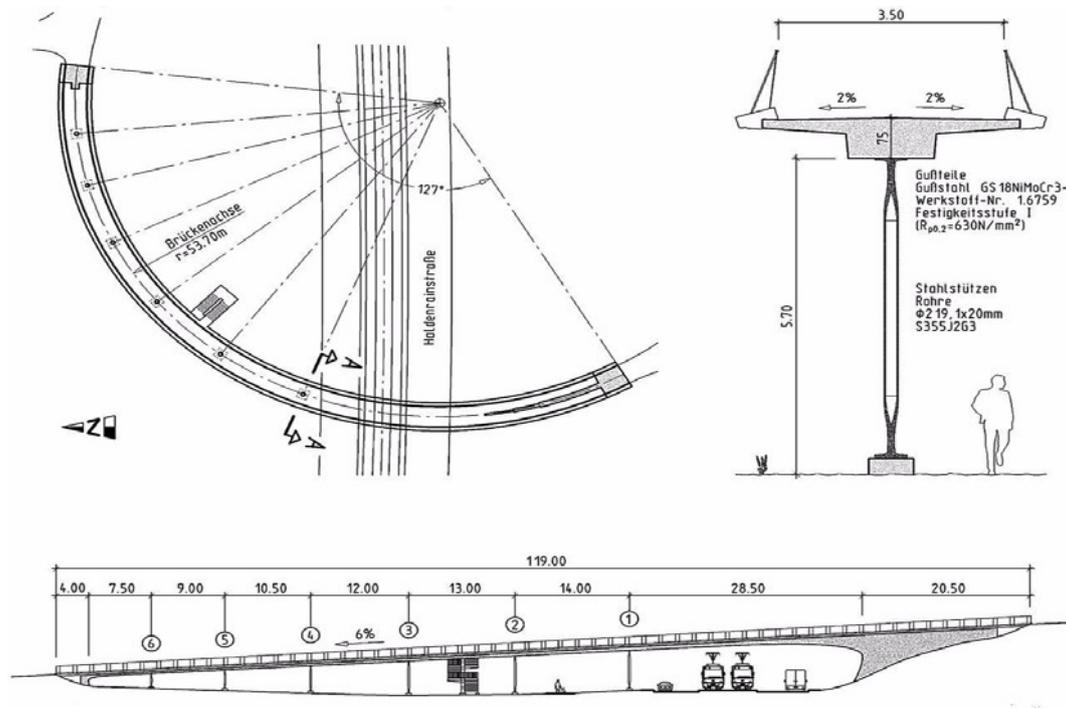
Grundriss, Ansicht und Schnitt des La-Ferté-Stegs [14]
